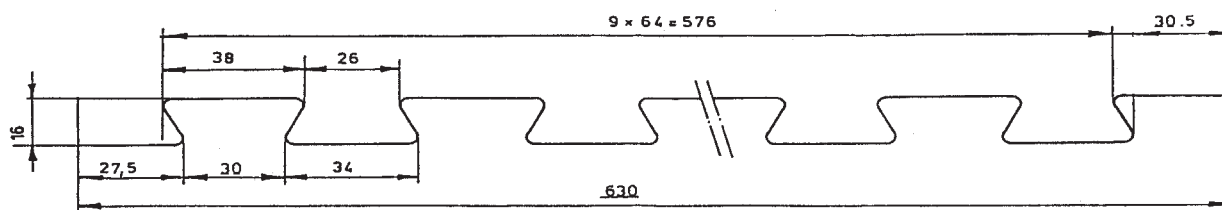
afmetingen zwaluwstaartplaat (in mm)
